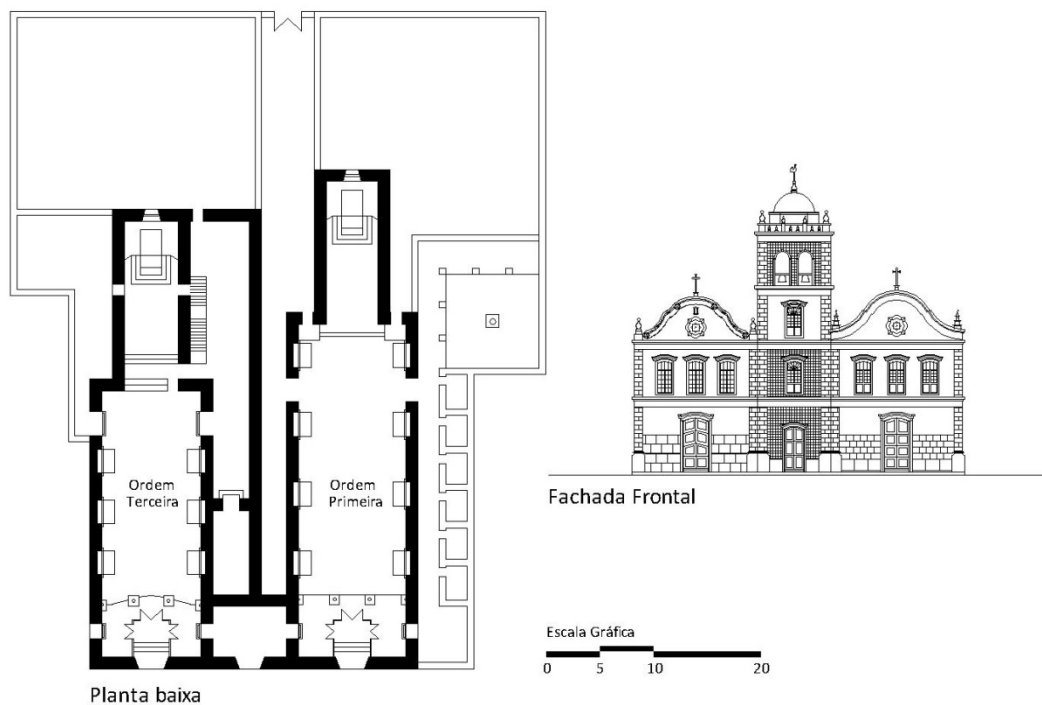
Planta e fachada do Conjunto do Carmo – desenho M. Monte Mór
